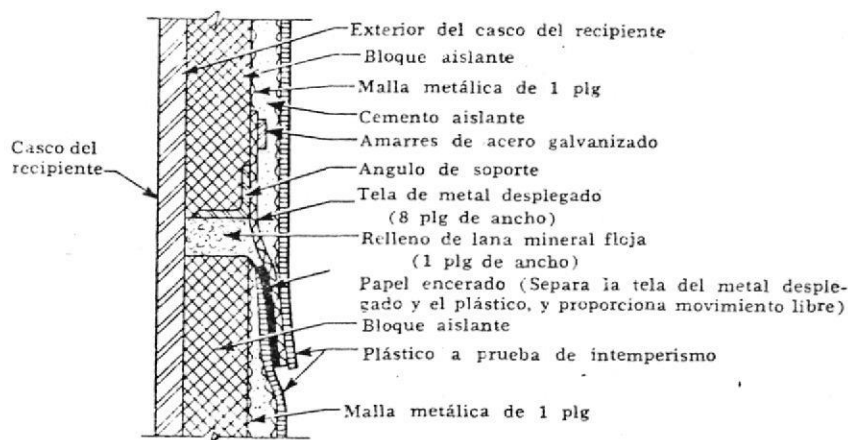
JUNTA TÍPICA DE EXPANSION PARA AISLAMIENTO DE BLOQUE
